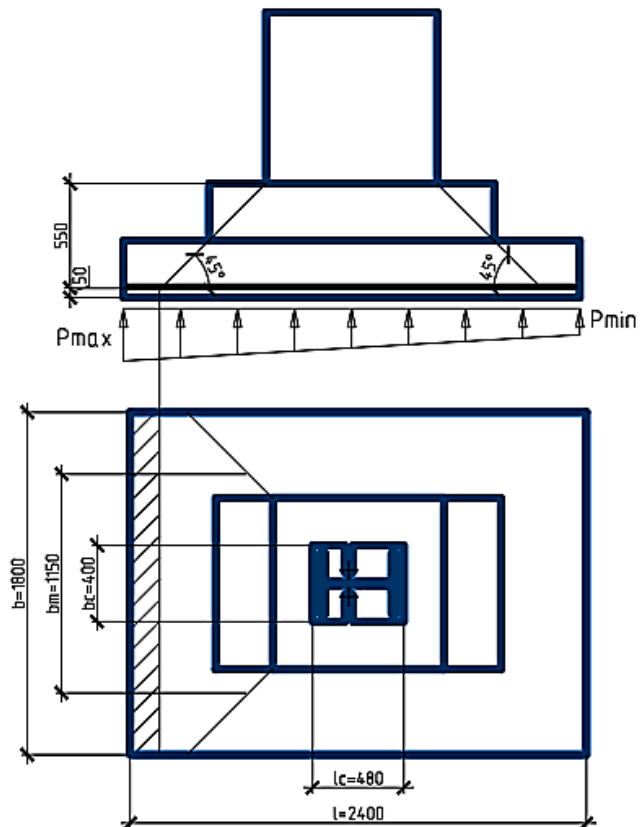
Схема к расчету низкого фундамента на продавливание подколонником
